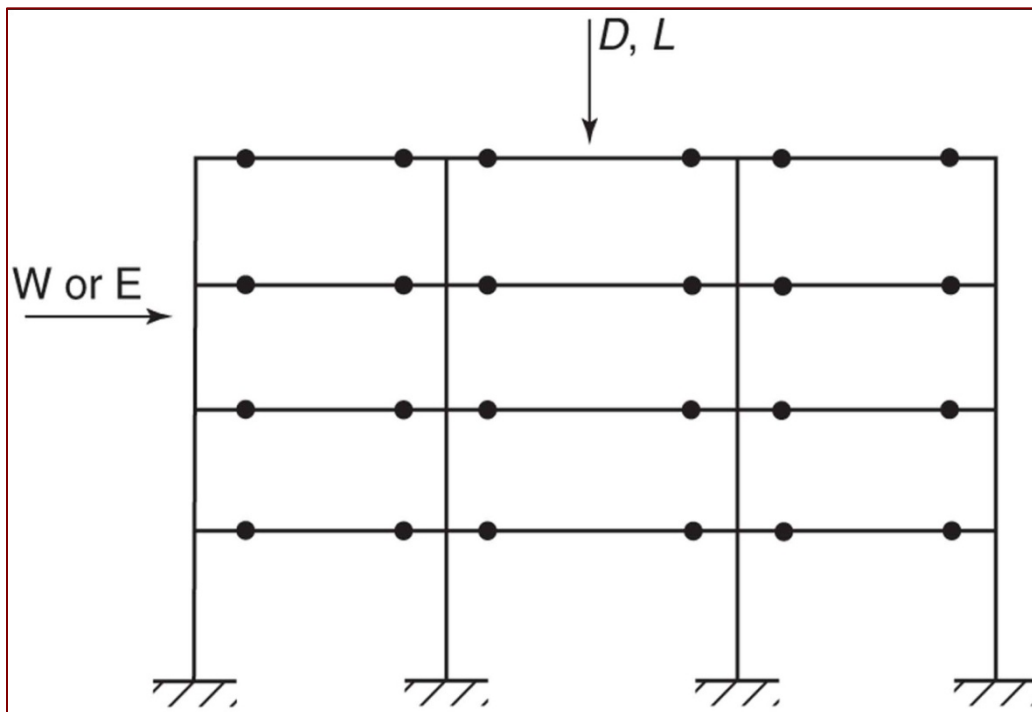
Modelo de pórtico equivalente para análisis de pórtico losa-columna sujeto a cargas gravitacionales y laterales.
